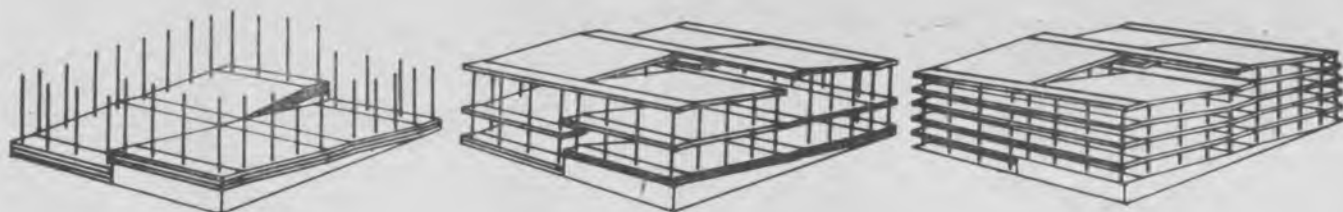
Каркас многоэтажного сооружения с непрерывными перекрытиями в виде сочленения наклонных и горизонтальных элементов
